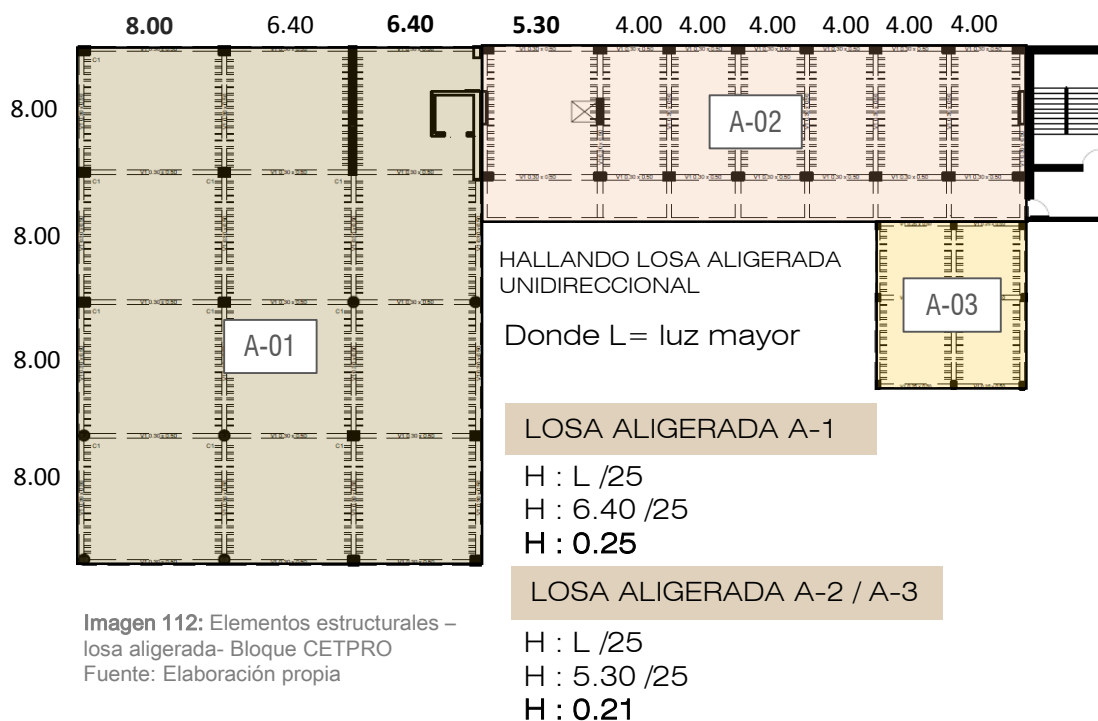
Elementos estructurales – losa aligerada- Bloque CETPRO
